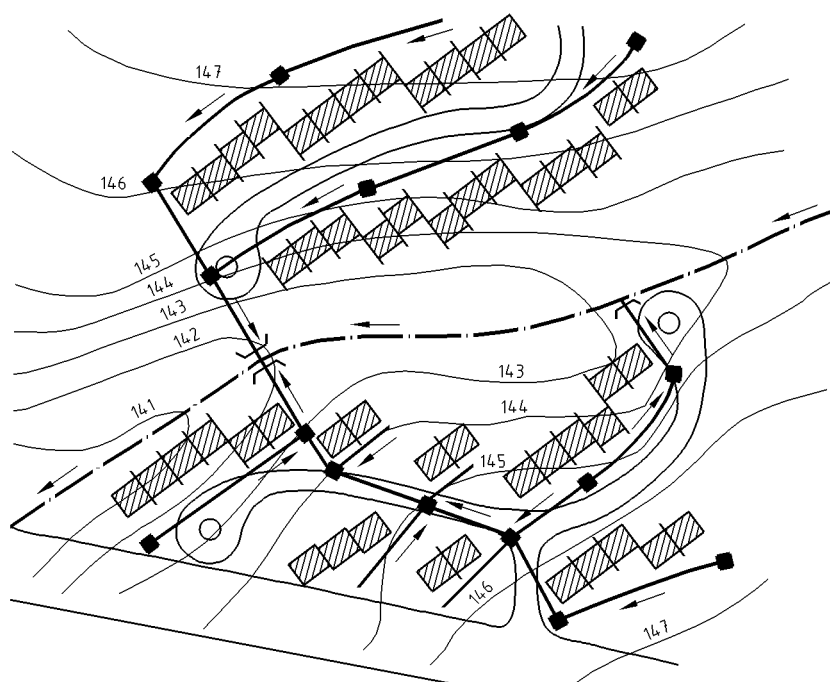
Exemple de drainage collectif d'un lotissement sur un terrain sensiblement plat
